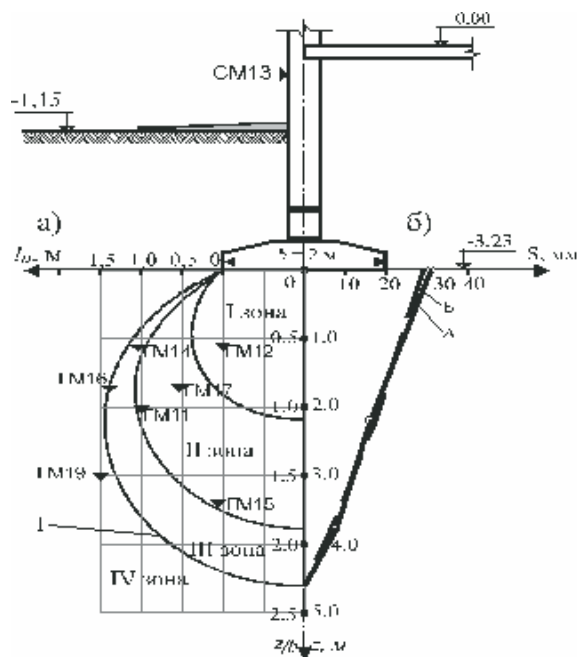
Ленточный фундамент 12-этажного жилого дома
